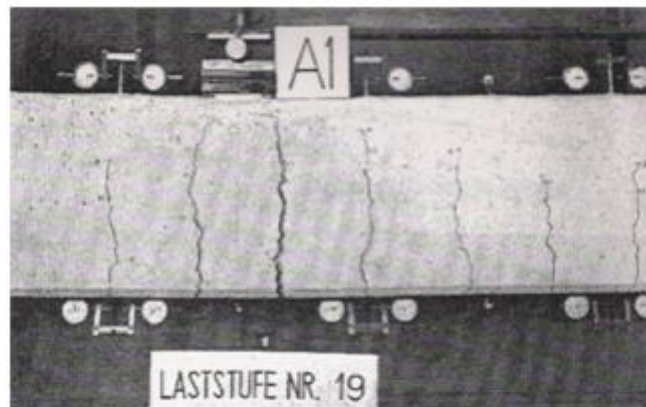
Viga sujeita a fissuras causadas pelo esforço de flexão.
